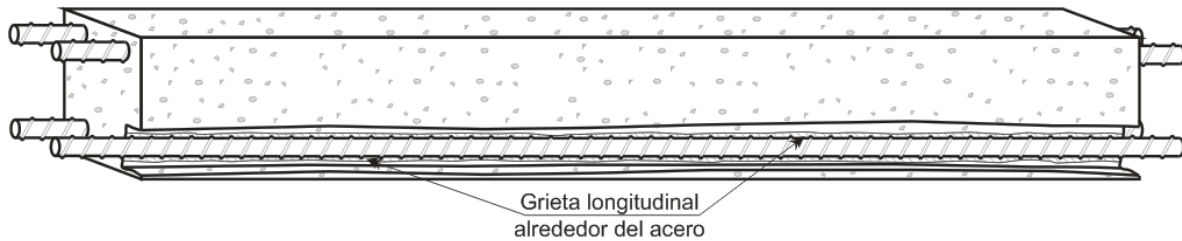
Grietas longitudinales por falta de adherencia.
